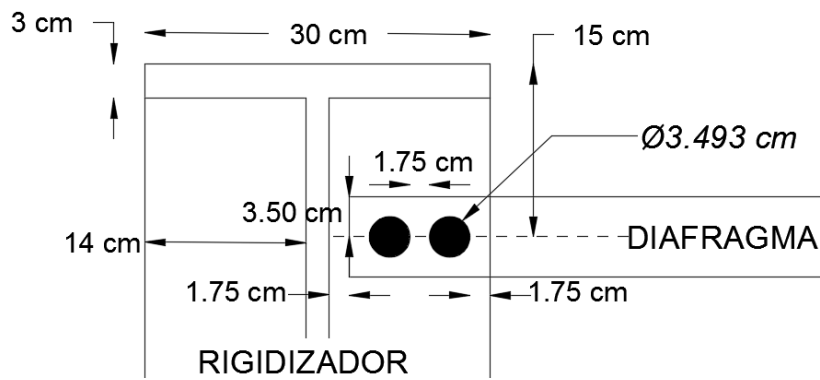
Vista conexión rigidizador transversal intermedio y contraviento horizontal. Realizado por: Autor
